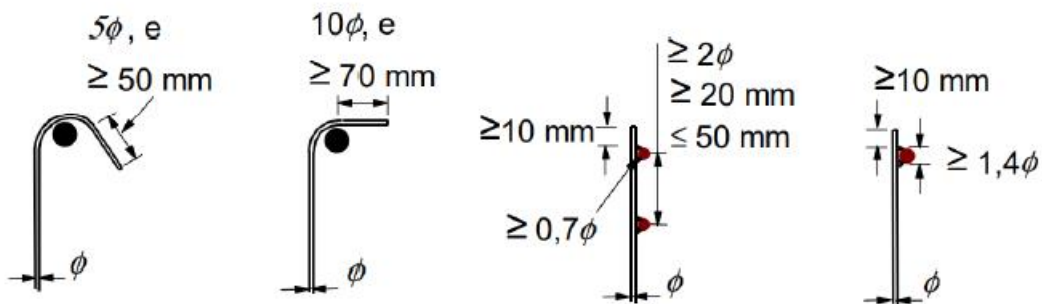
Ilustração das regras das amarrações das armaduras transversais.
